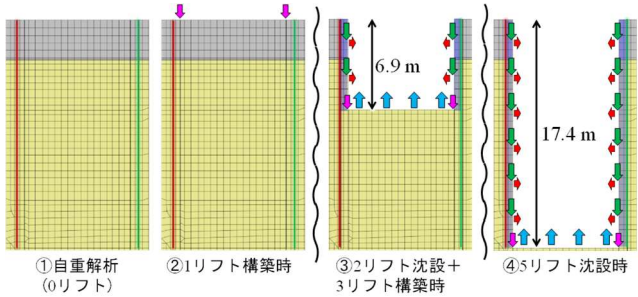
施工ステップ毎の荷重モデル概要図(C-C断面)
